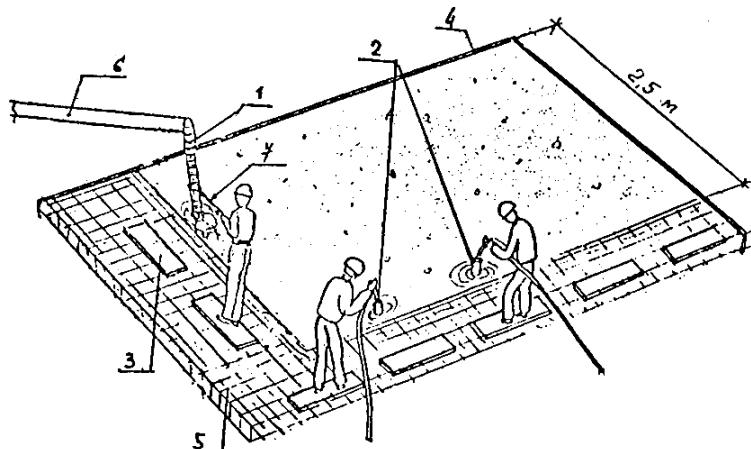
Схема организации рабочего места при бетонировании монолитной плиты
